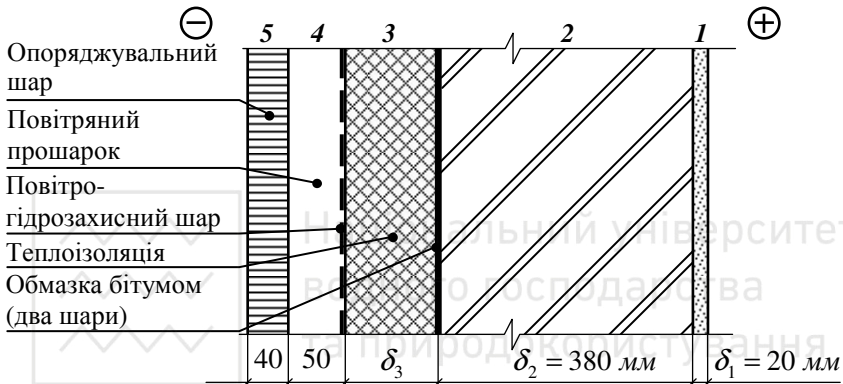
Розрахункова схема стіни вентиляованого фасаду
